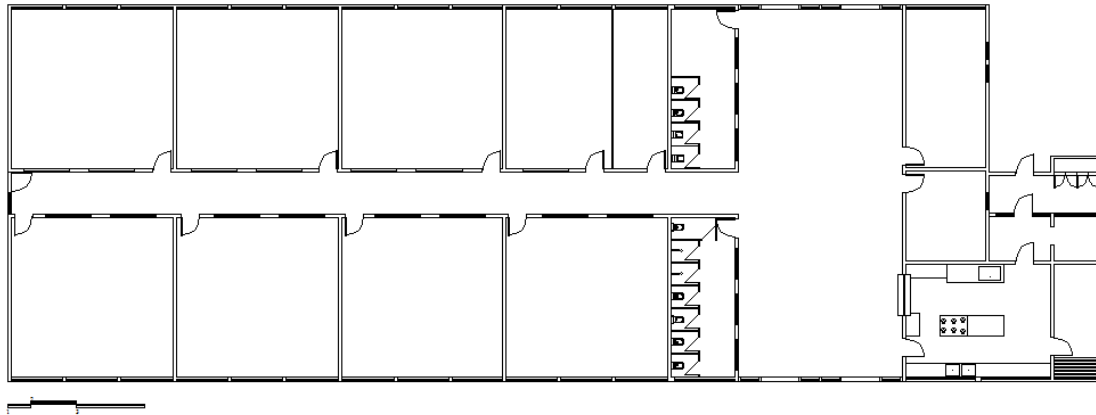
Planta Baixa Escola Municipal Dalva Ana Bortolini
